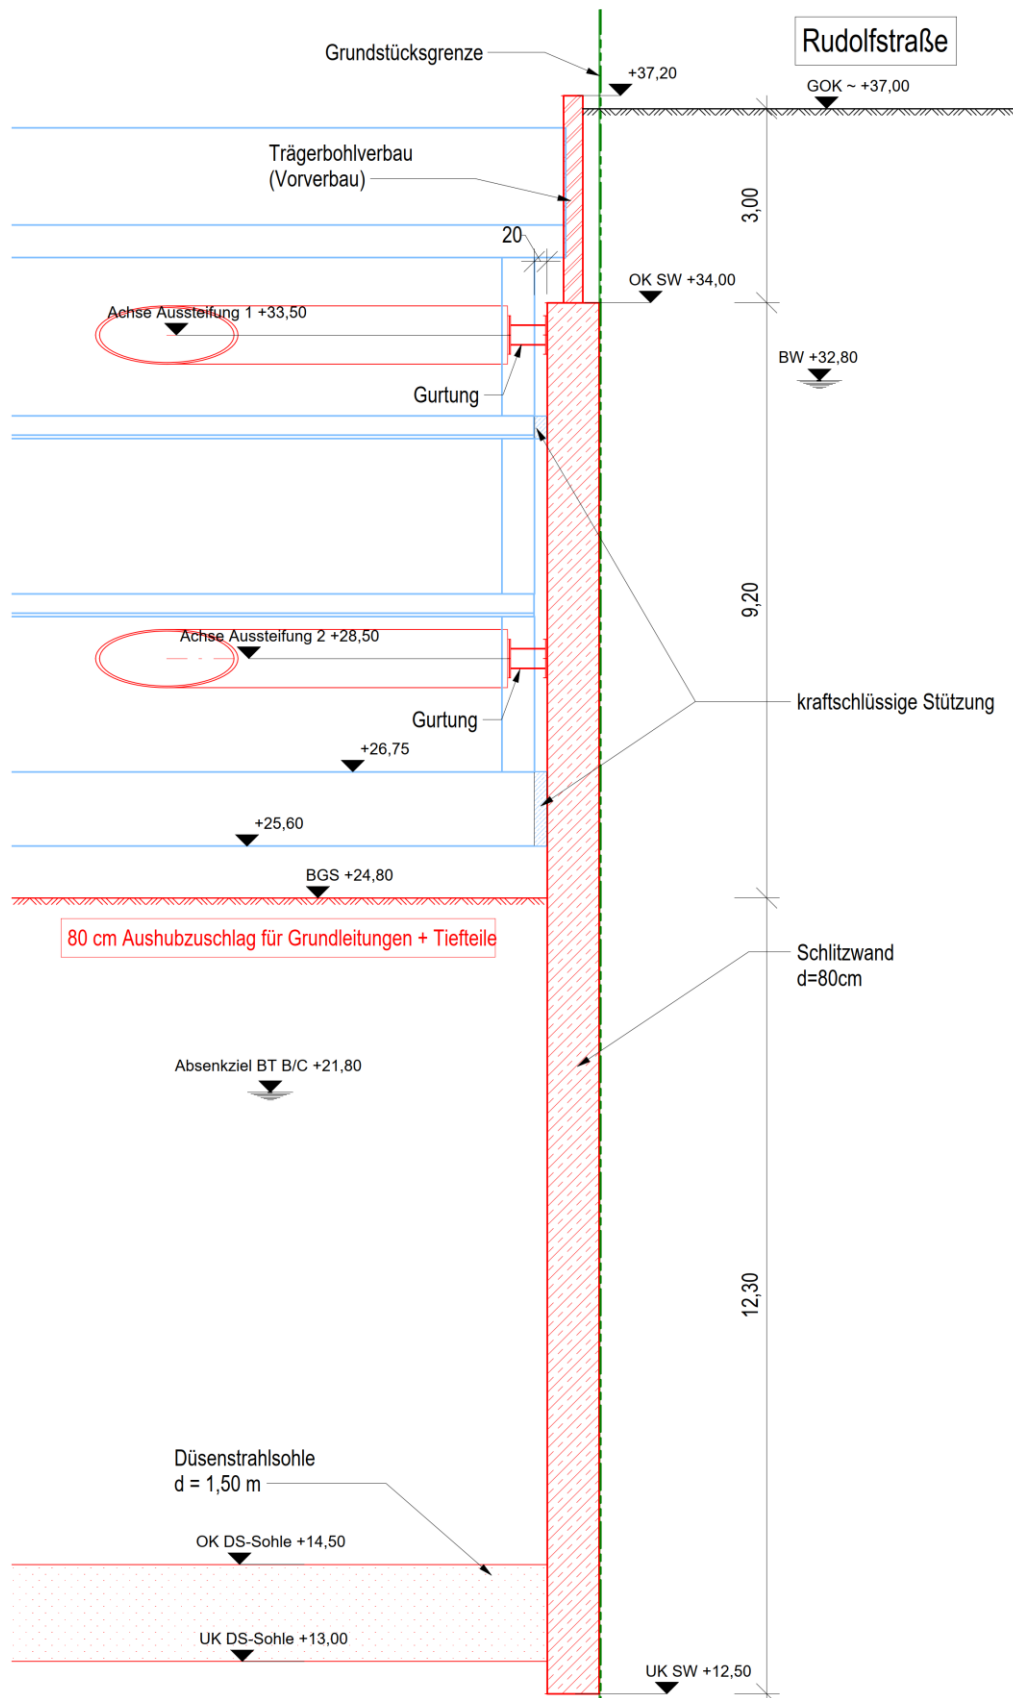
Baugrube Bauteil B – Schnitt 2 (aus [U 7])
